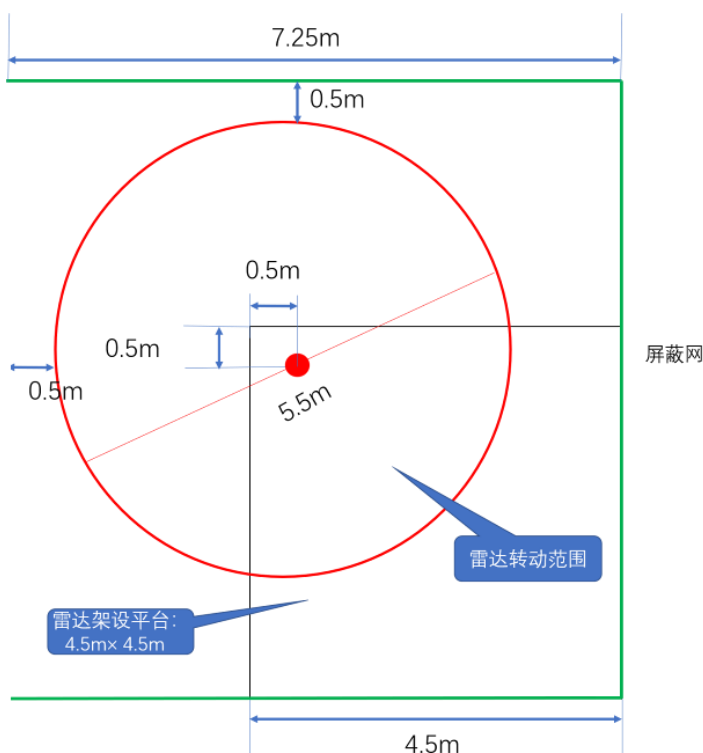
大蒲河站屏蔽网设置平面示意图
